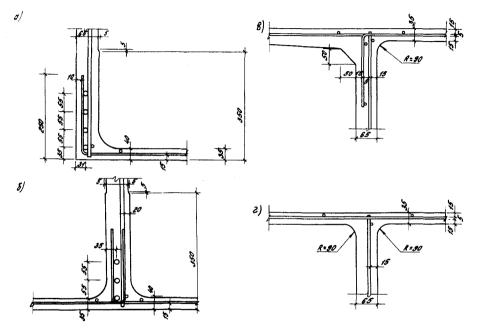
Схема размещения арматуры в поперечном сечении нижней (а,б) и верхней (в,г) зоны коробчатого настила
